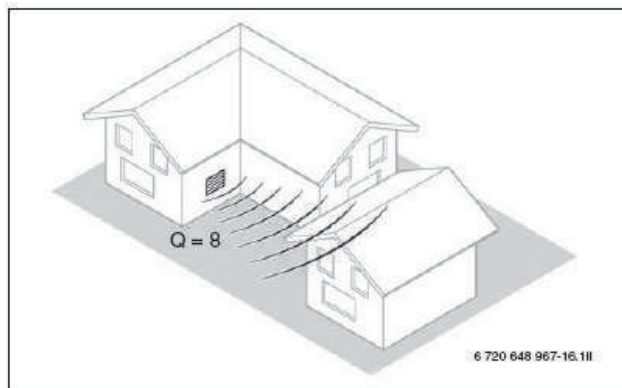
Тепловой насос или вход / выход воздуха (при внутреннем размещении) на стене дома для выступающего угла фасада. Звуковое излучение в одну восьмую пространства ($Q = 8$);
